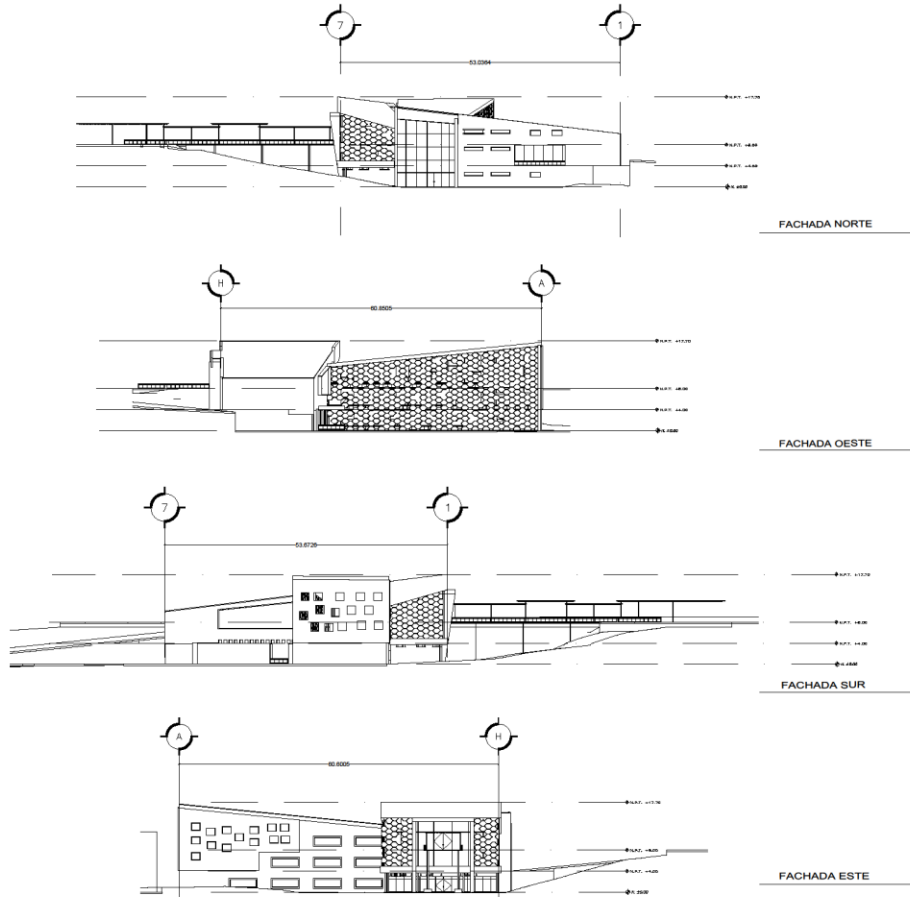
Fachadas arquitectónicas Centro cultural UACM plantel Cuatepec. Creación propia.
